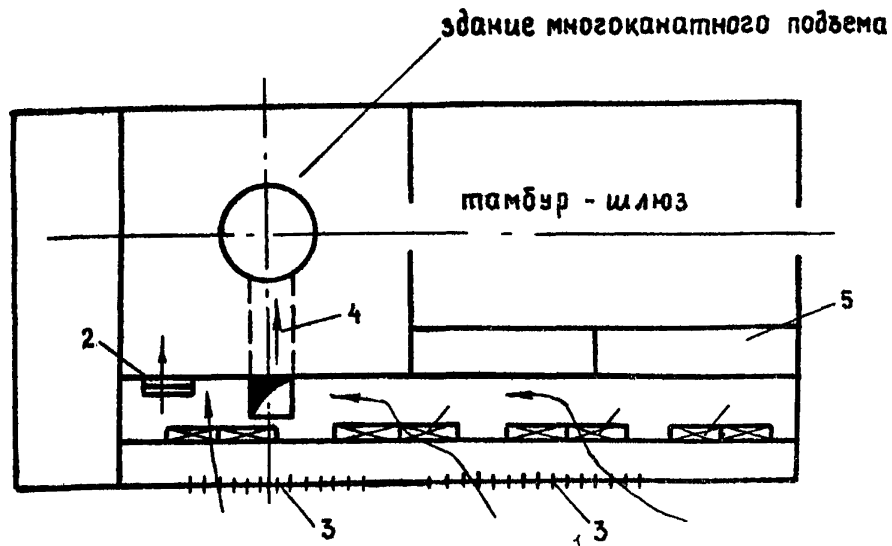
Схема расположения воздухоподогревательной установки при стволах, оборудованных многоканатными подъемными установками: 1-группа воздухоподогревателей; 2-многостворчатый клапан; 3-железная решетка; 4-воздухоподогревательный канал; 5-узел управления воздухоподогревательной установкой
